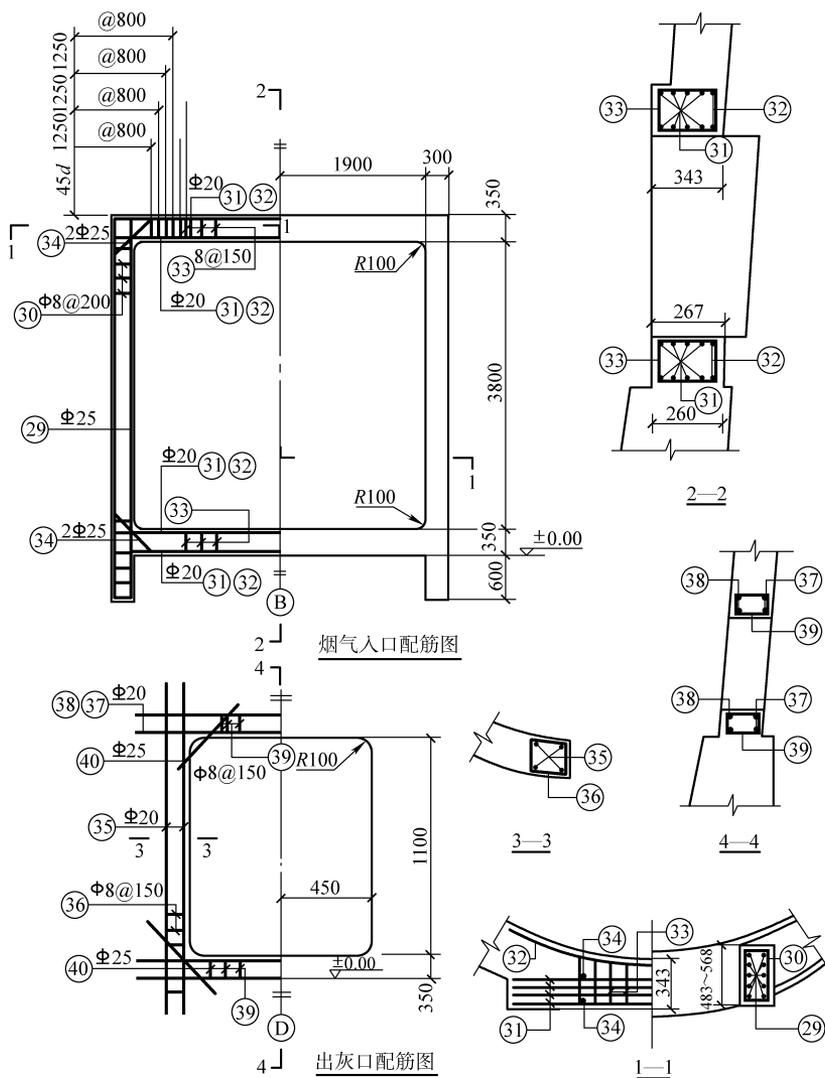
60m 高钢筋混凝土烟囱出灰口配筋图
